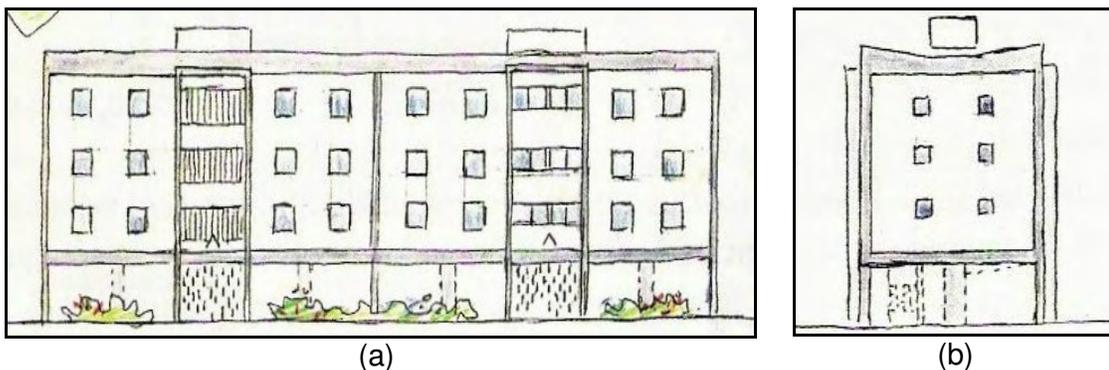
Fachadas dos edifícios: (a) fachada frontal; (b) fachada lateral.
